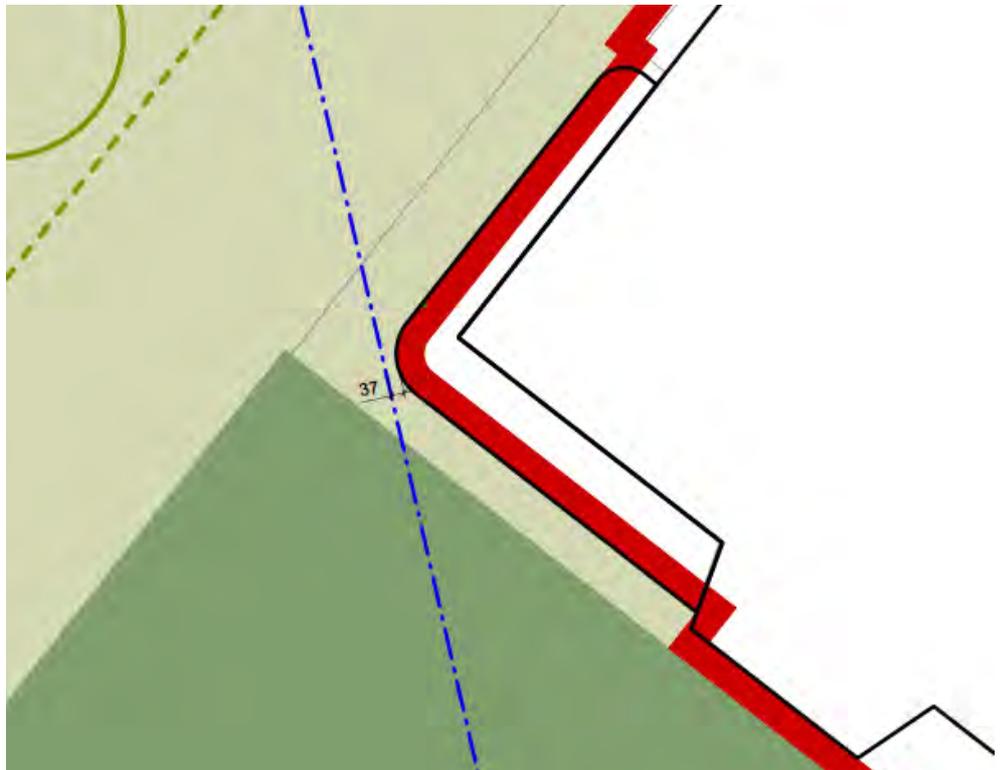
Verlauf südwestliche Ecke des Baubereichs A1 entlang der bestehenden Gebäudeflucht [Lohner + Partner AG]
